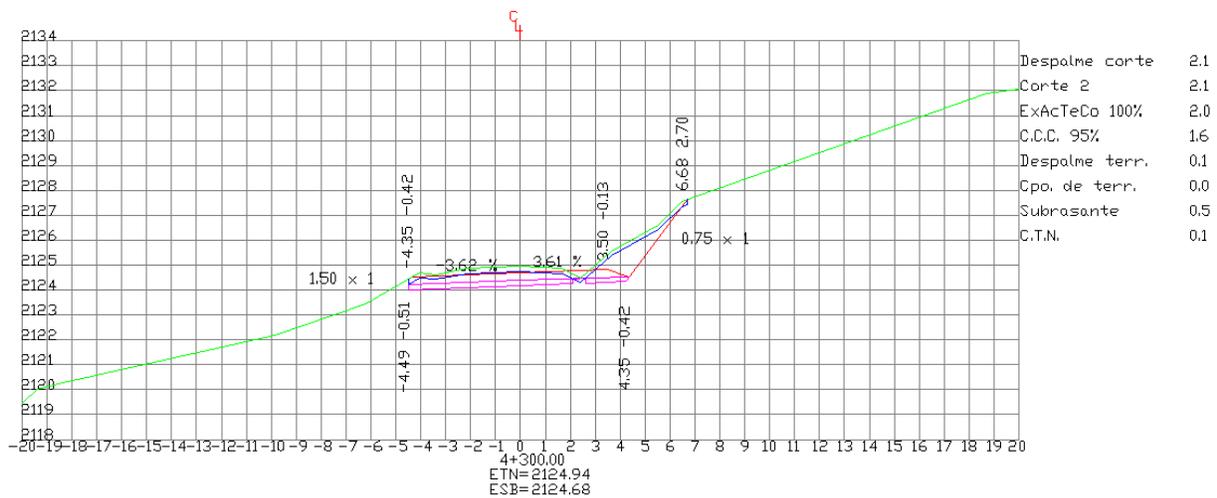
Sección transversal, km 4+300, en zona donde se requiere defensa metálica lado izquierdo.
